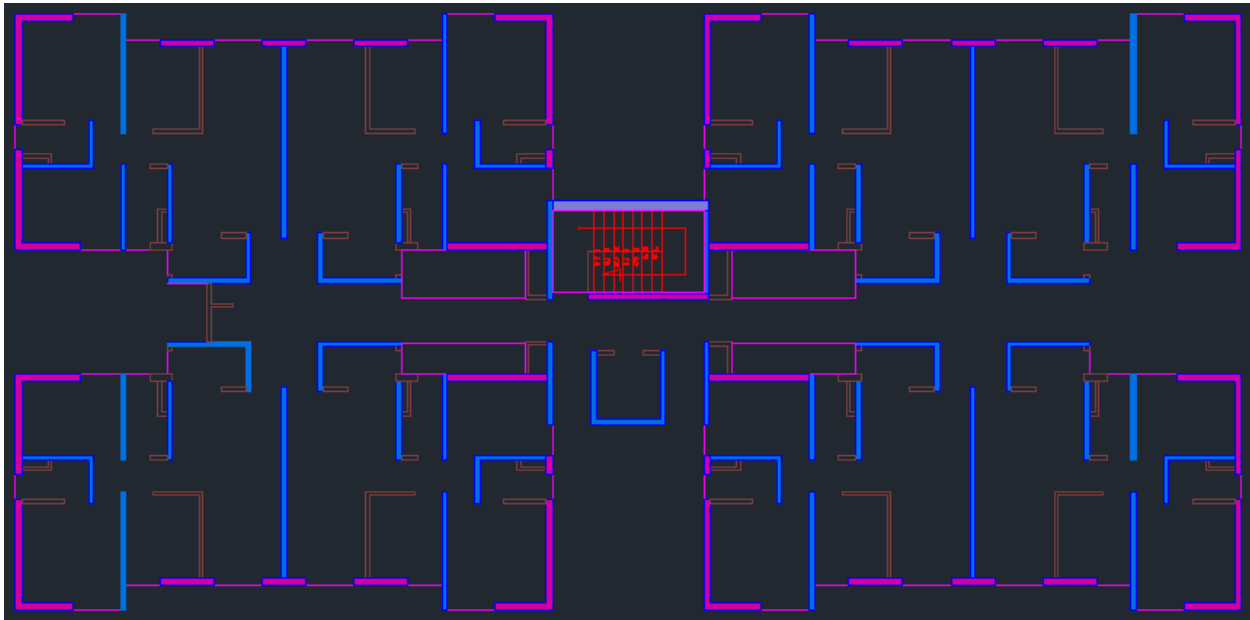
Planta de muros estructurales 2° a 10° piso
